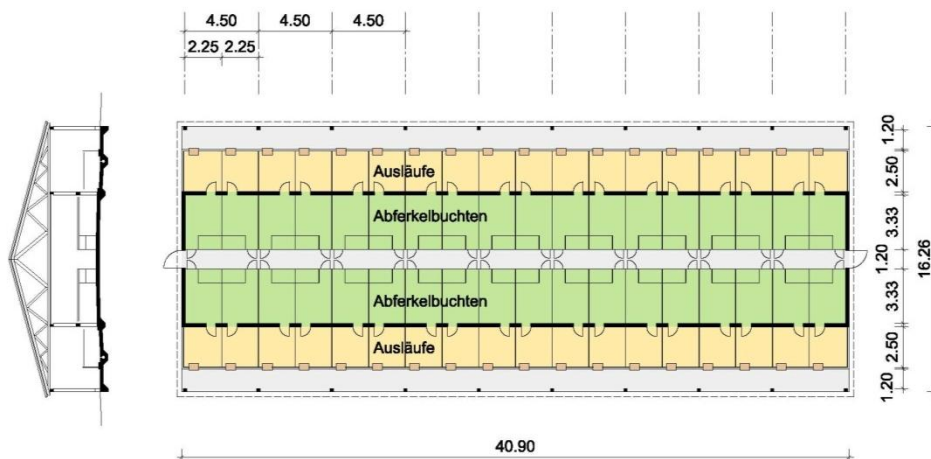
Grundriss, Ansichten und Schnitt des Abferkelstallabteils mit außenliegender Fütterung
